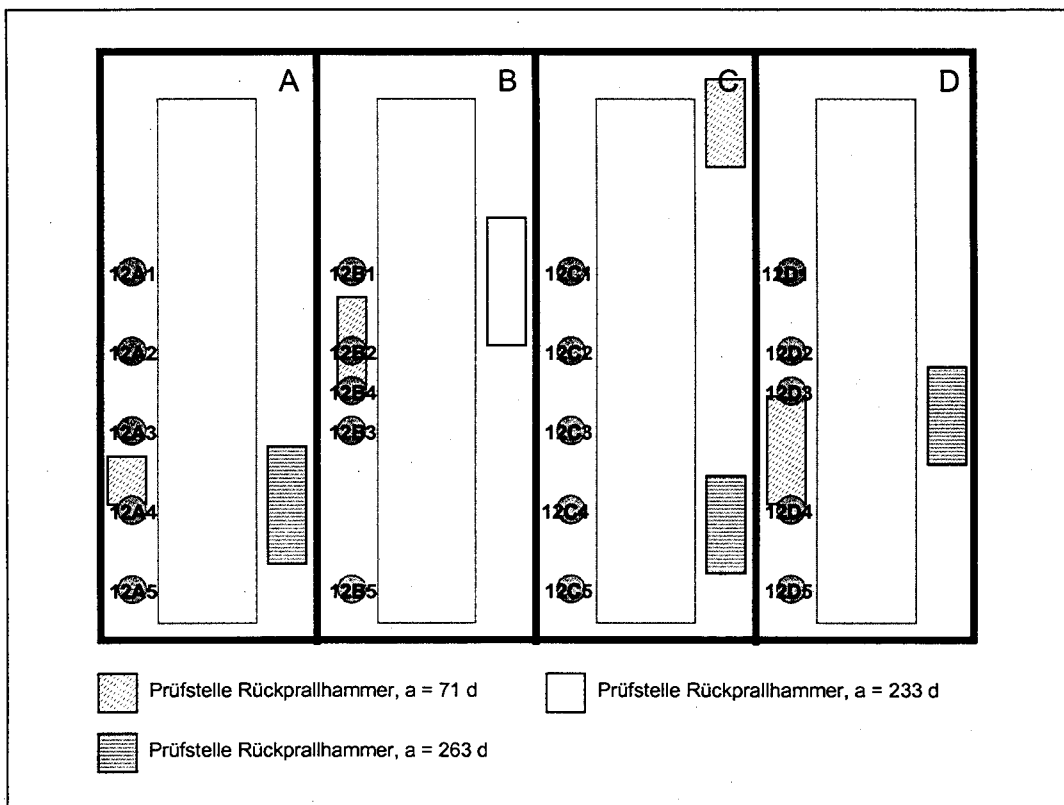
Lage der Prüfflächen am Betonkörper 9
